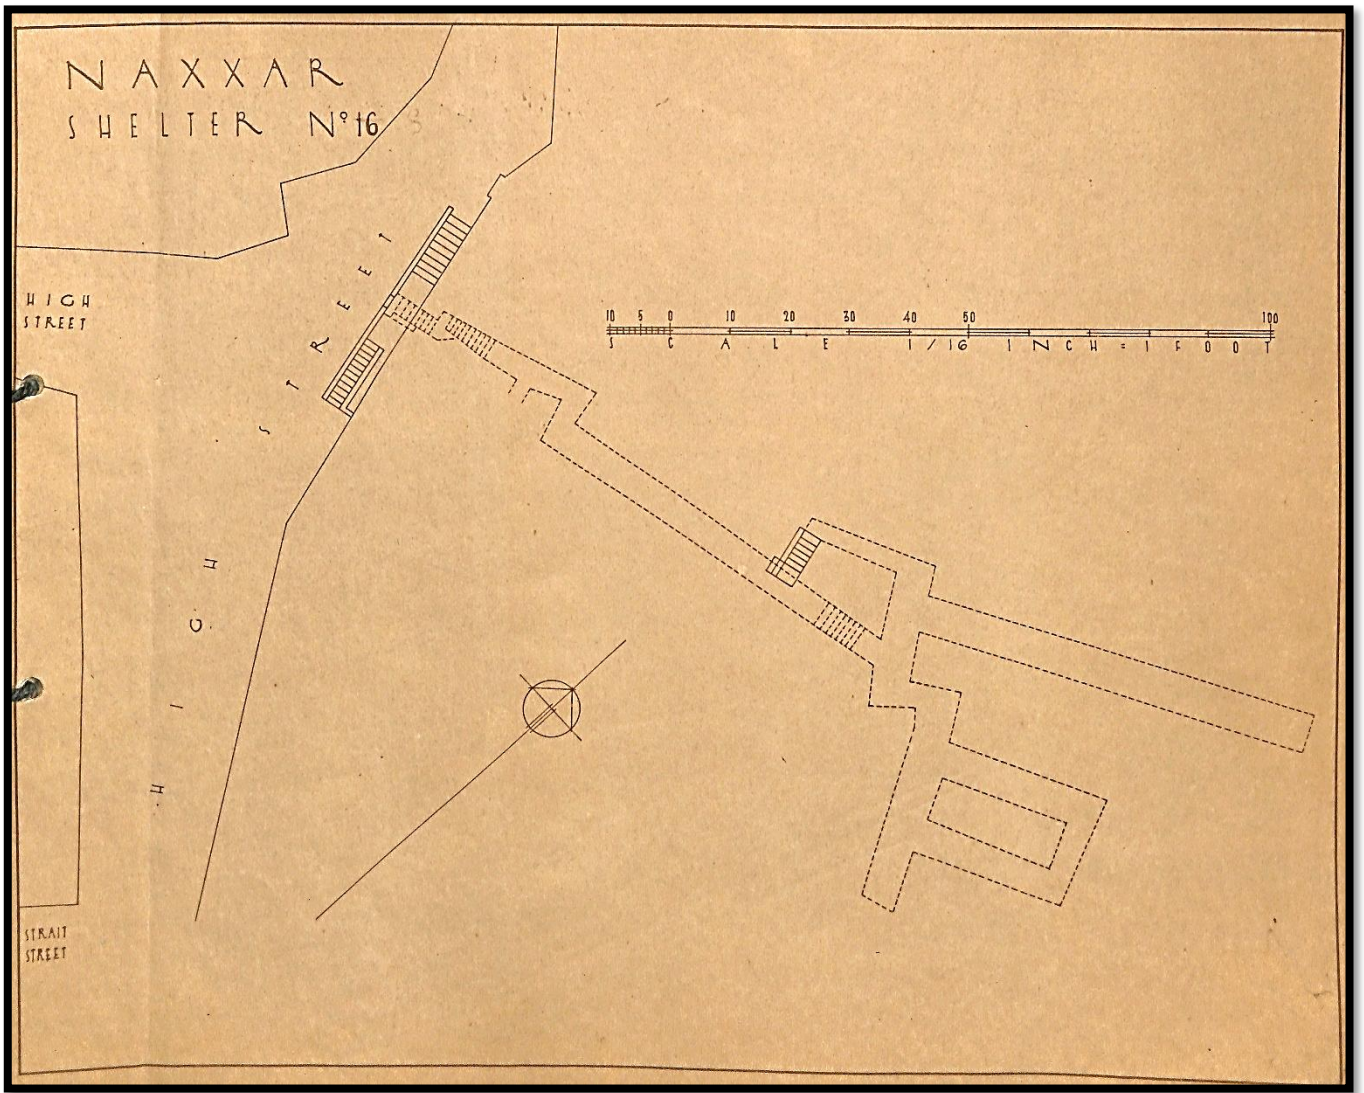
Planta do Abrigo nº16 (3) "High Street"
